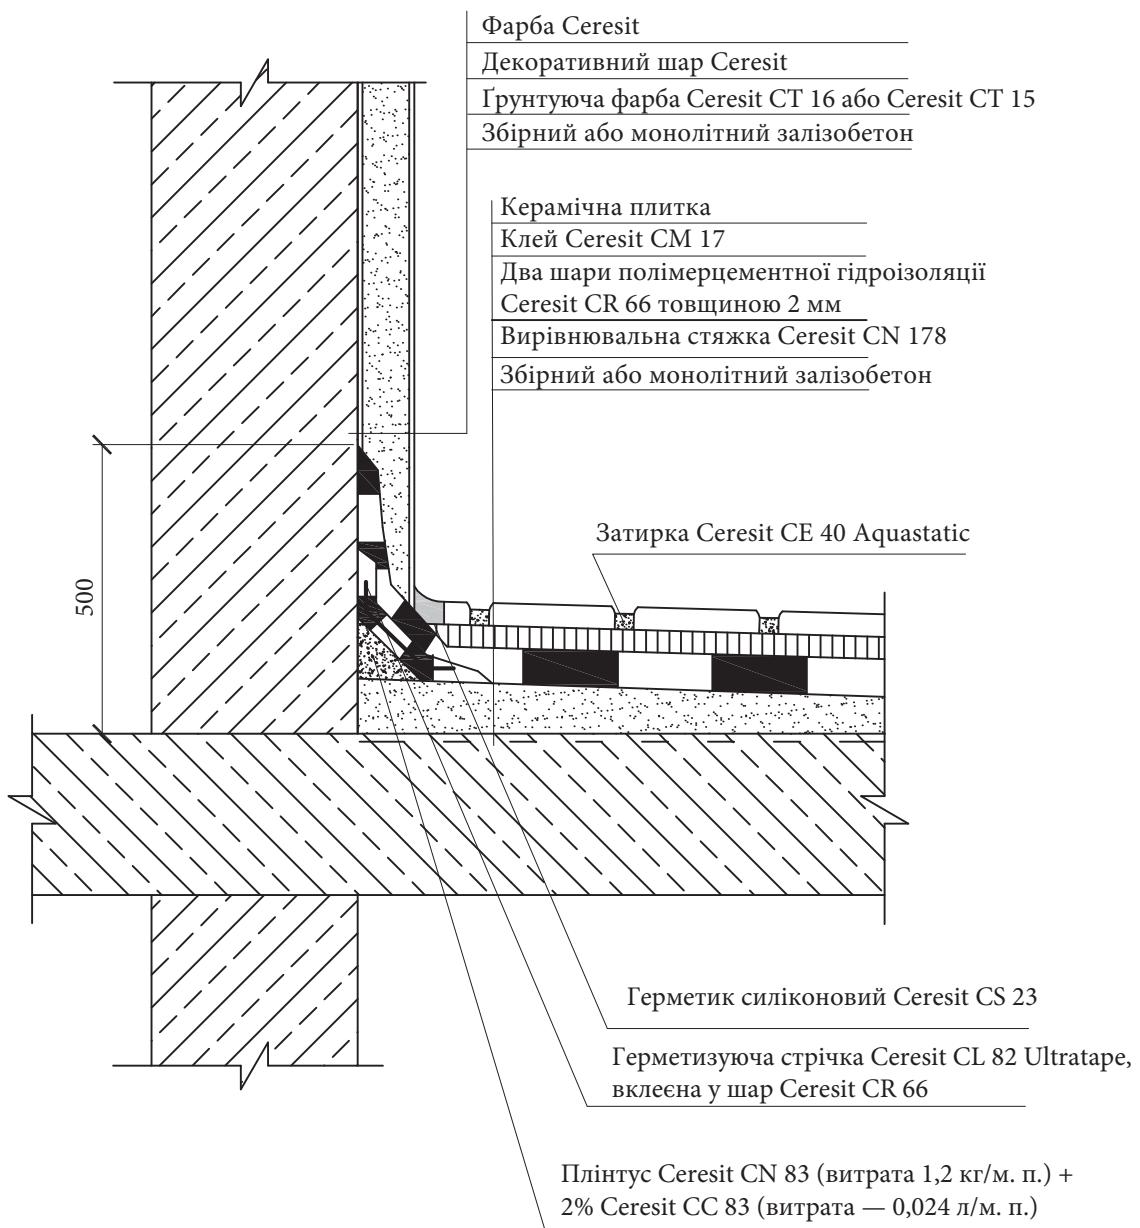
Конструкція гідроізоляції балконів без утеплення
